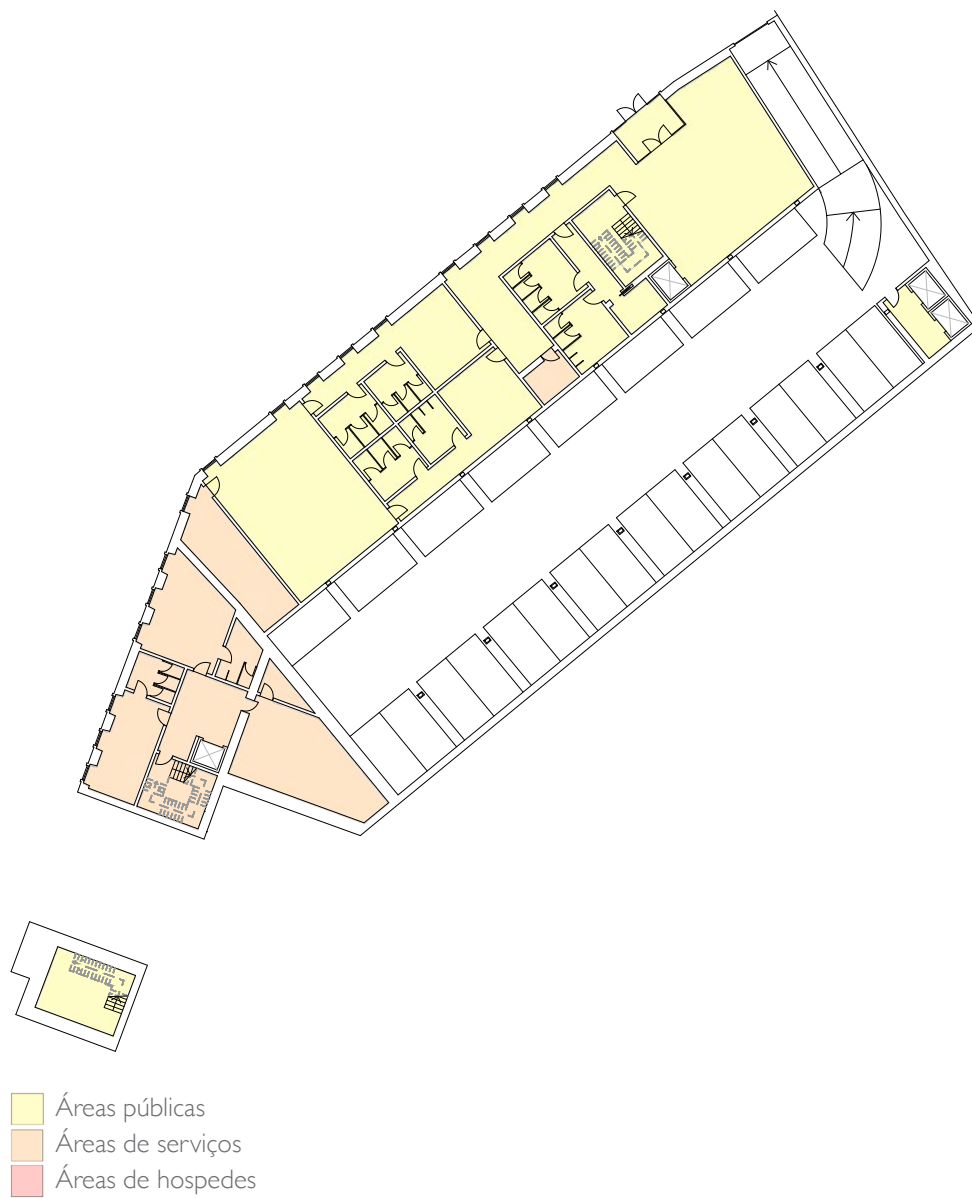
Planta do piso - 2, à escala 1:500, orientada a Norte
